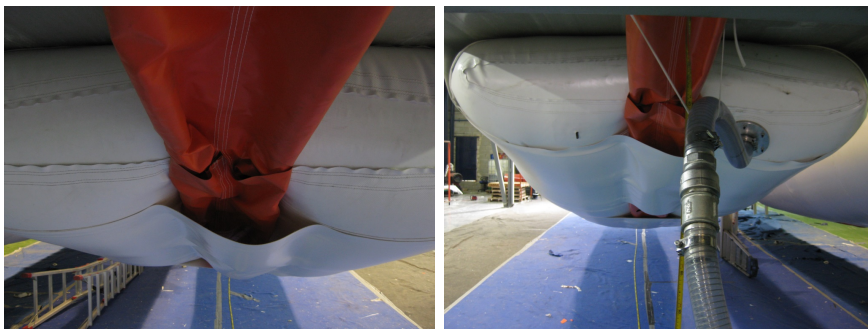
Penetración de la eslinga en el tubo y contacto tubo-tablero de la viga 2 con 10 tn de carga
